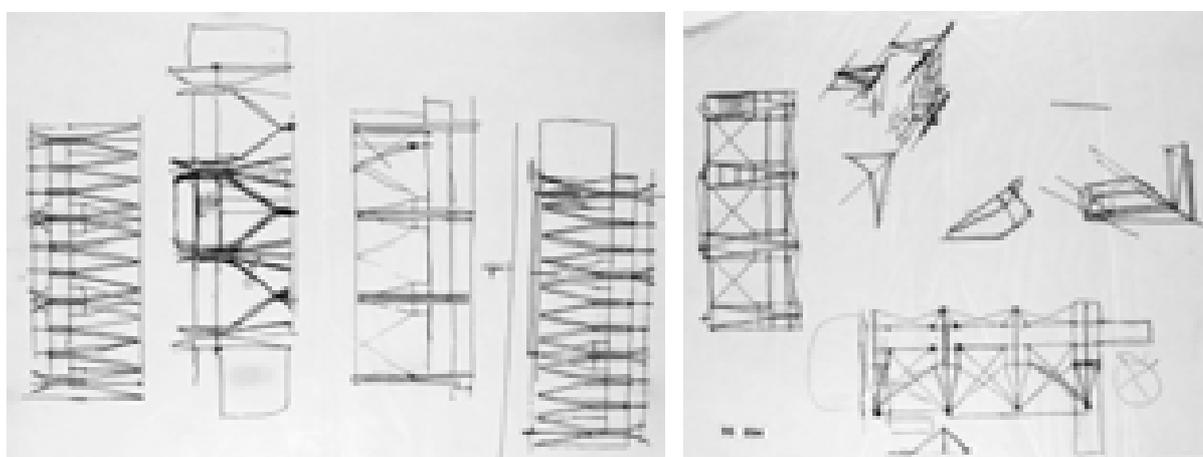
SX, Studio passerella in pianta – s.d. (AABS-95.067)
